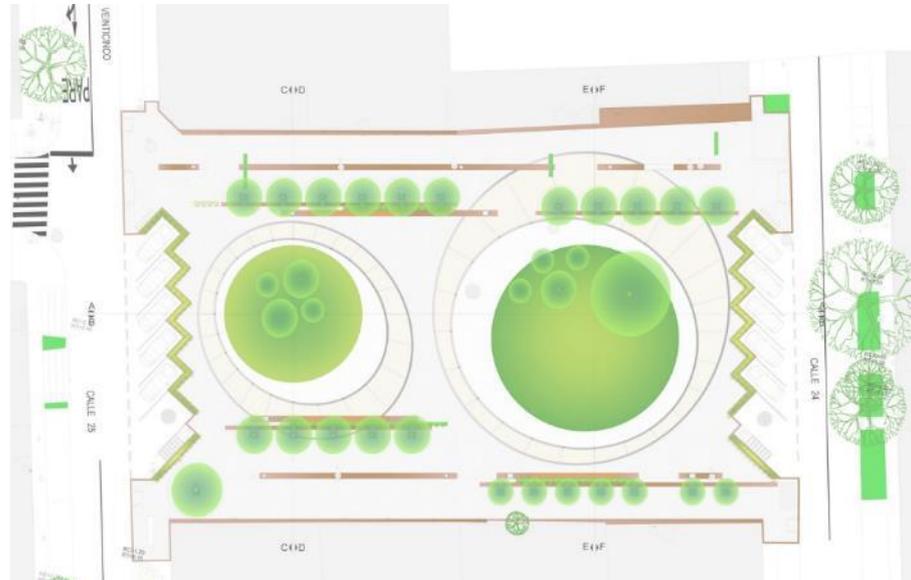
Plano de propuesta para el proyecto Plaza 31. Fuente: Archdayli.pe.
